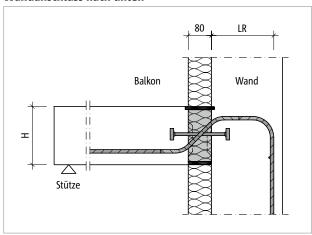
Schöck Isokorb® T Typ QP-WU: Wandanschluss nach unten bei Aussendämmung
